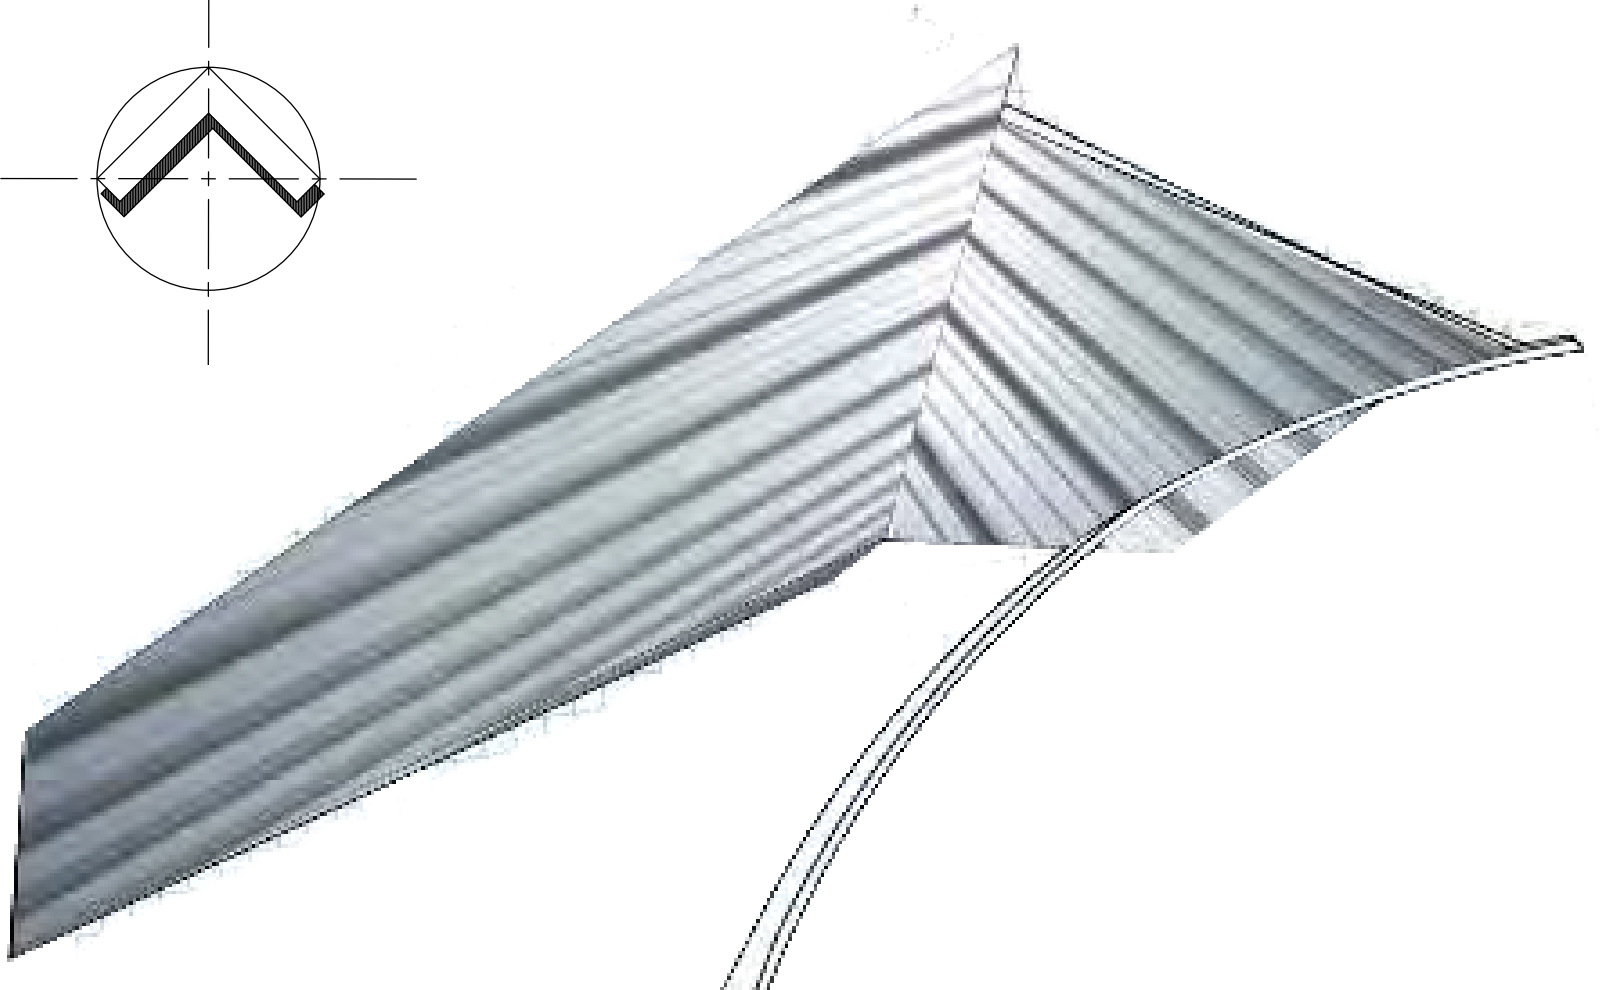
Siistema de cubierta de acero de junta alzada, detalle constructivo. Imagen recuperada de:
